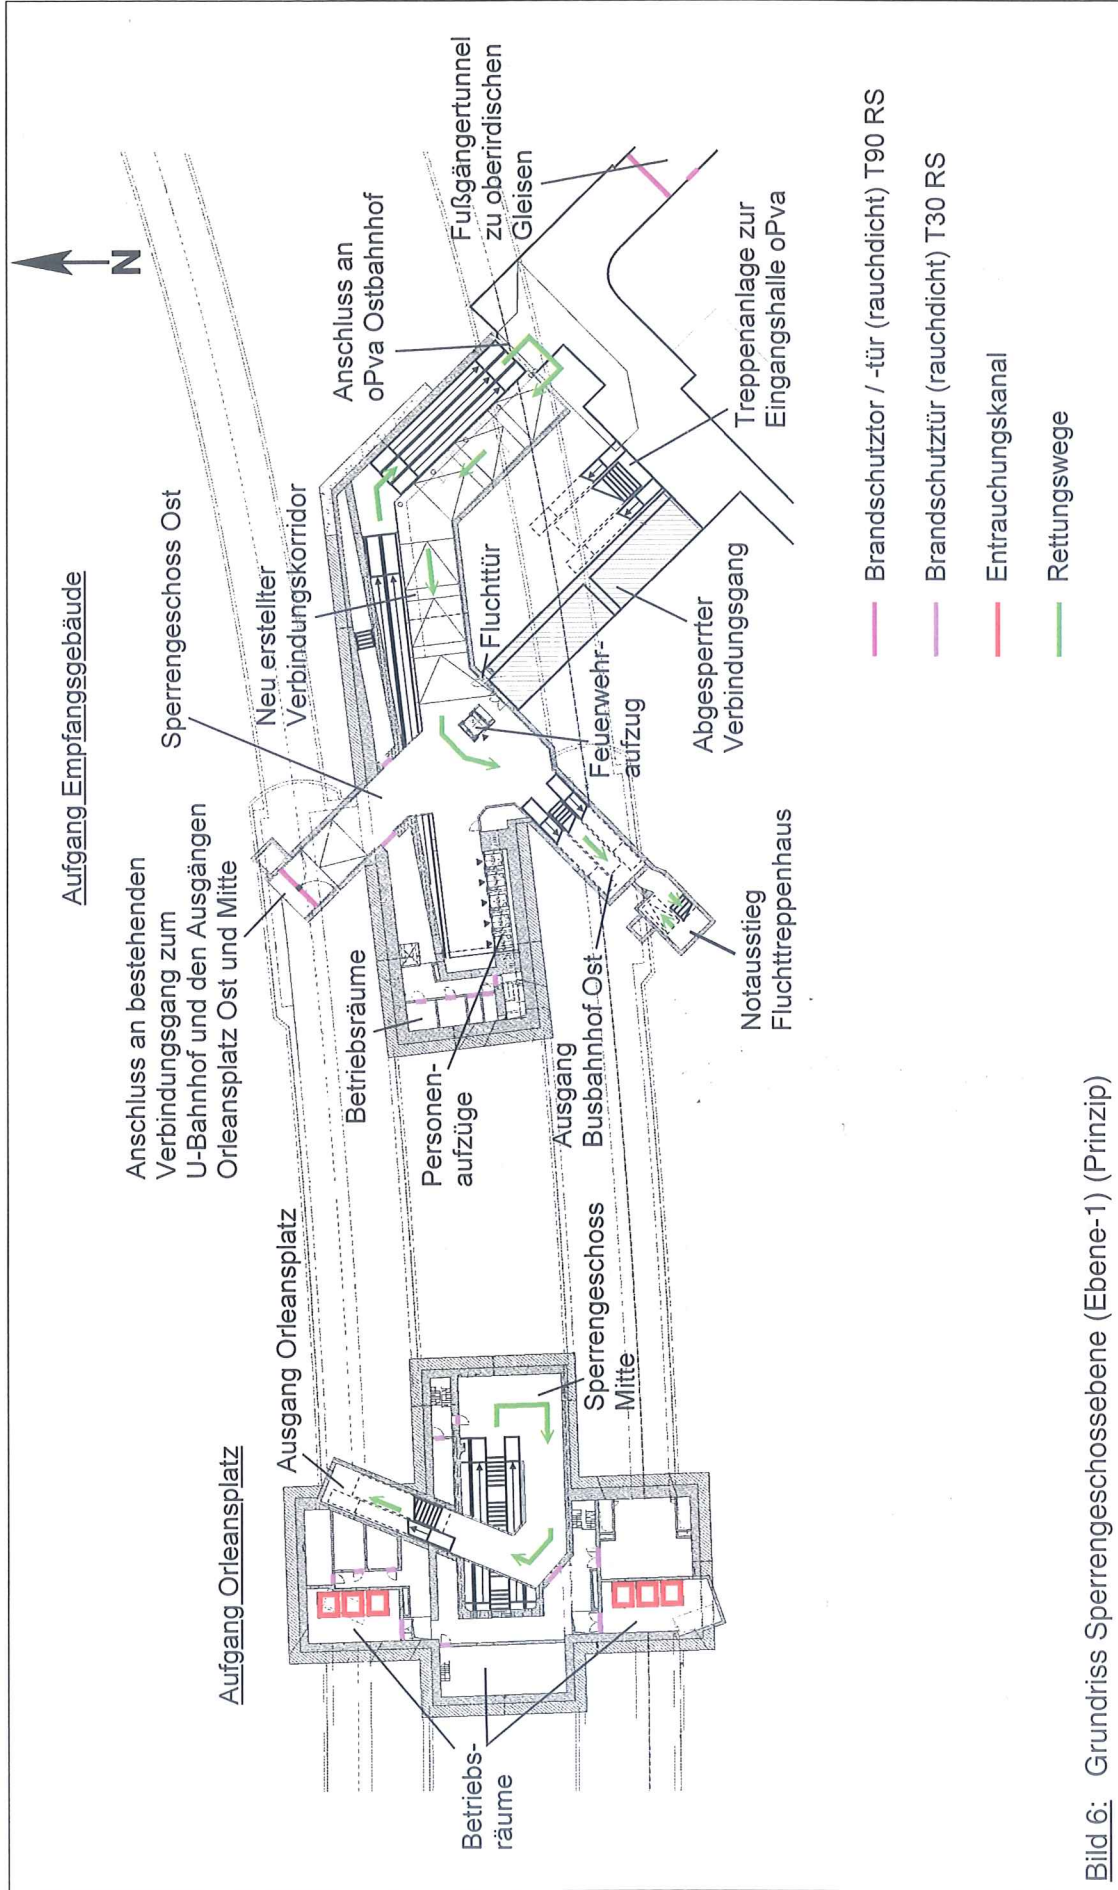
Grundriss Sperrengeschosebene (Ebene-1) (Prinzip)
